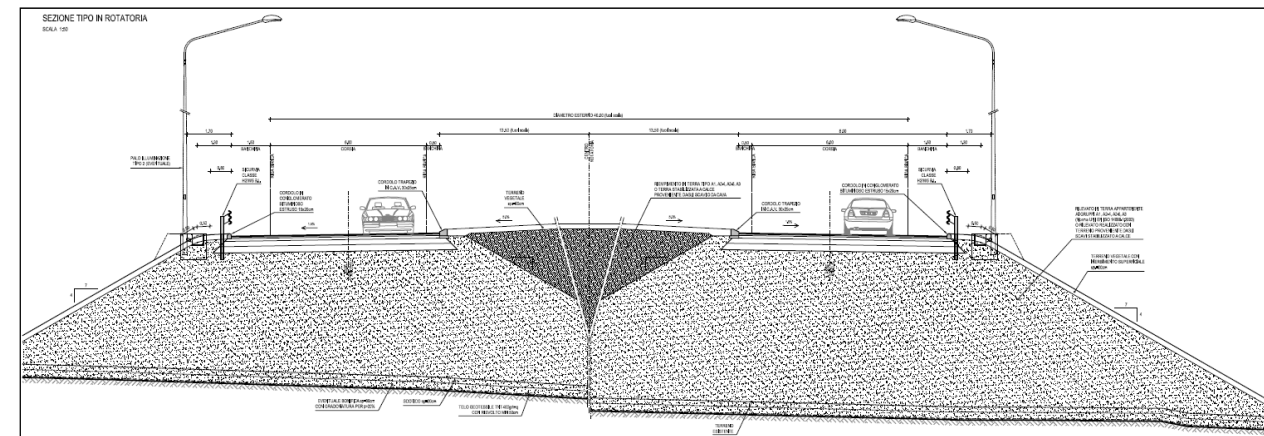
Esempio di sezione trasversale tipica di rotatoria
